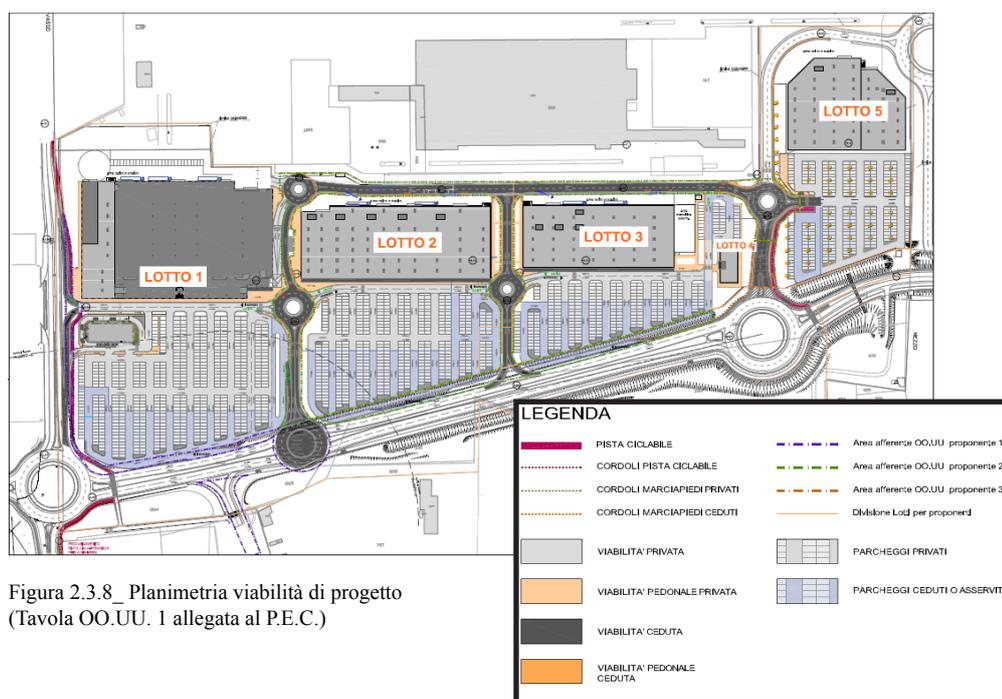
\_ Planimetria viabilità di progetto (Tavola OO.UU. 1 allegata al P.E.C.)
